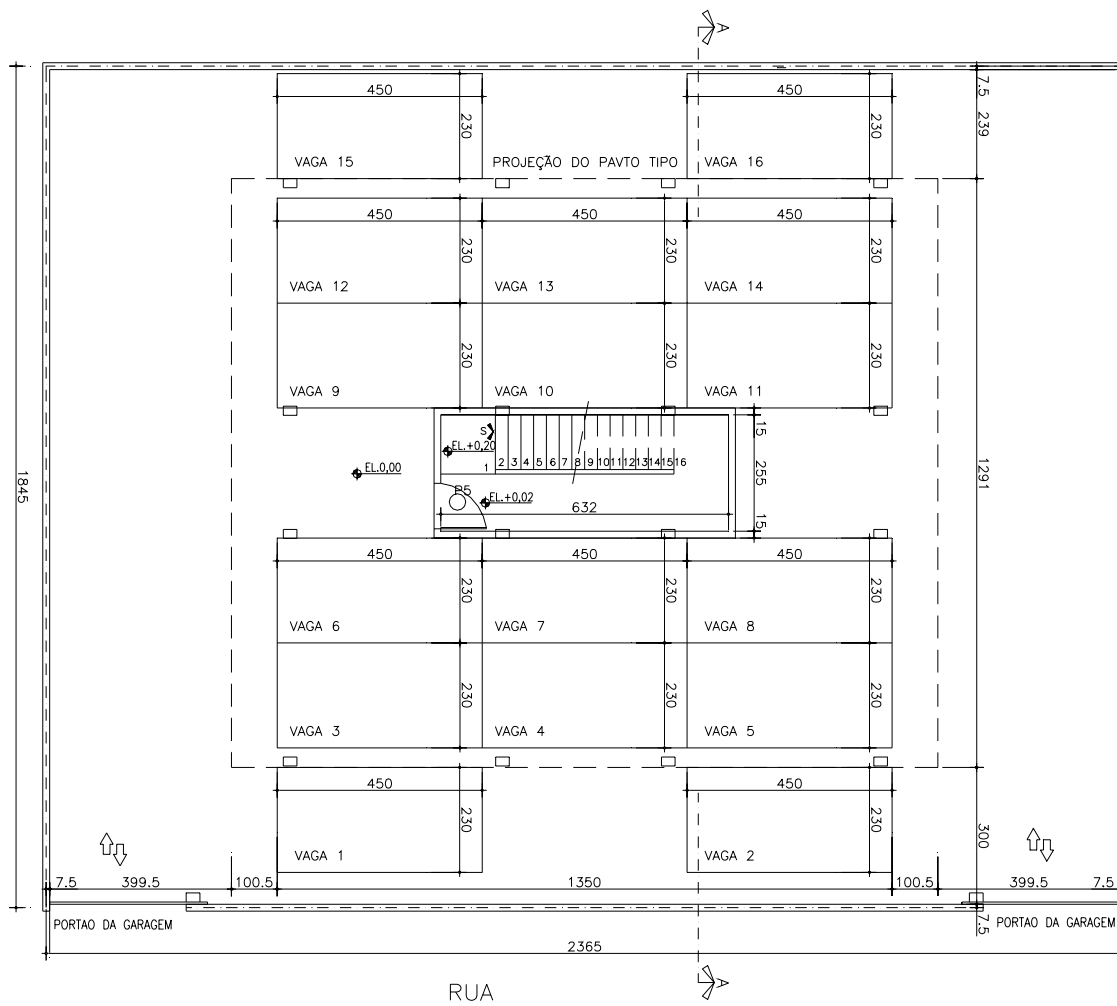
Prédio “M” – Opção 1 – Planta da Garagem
